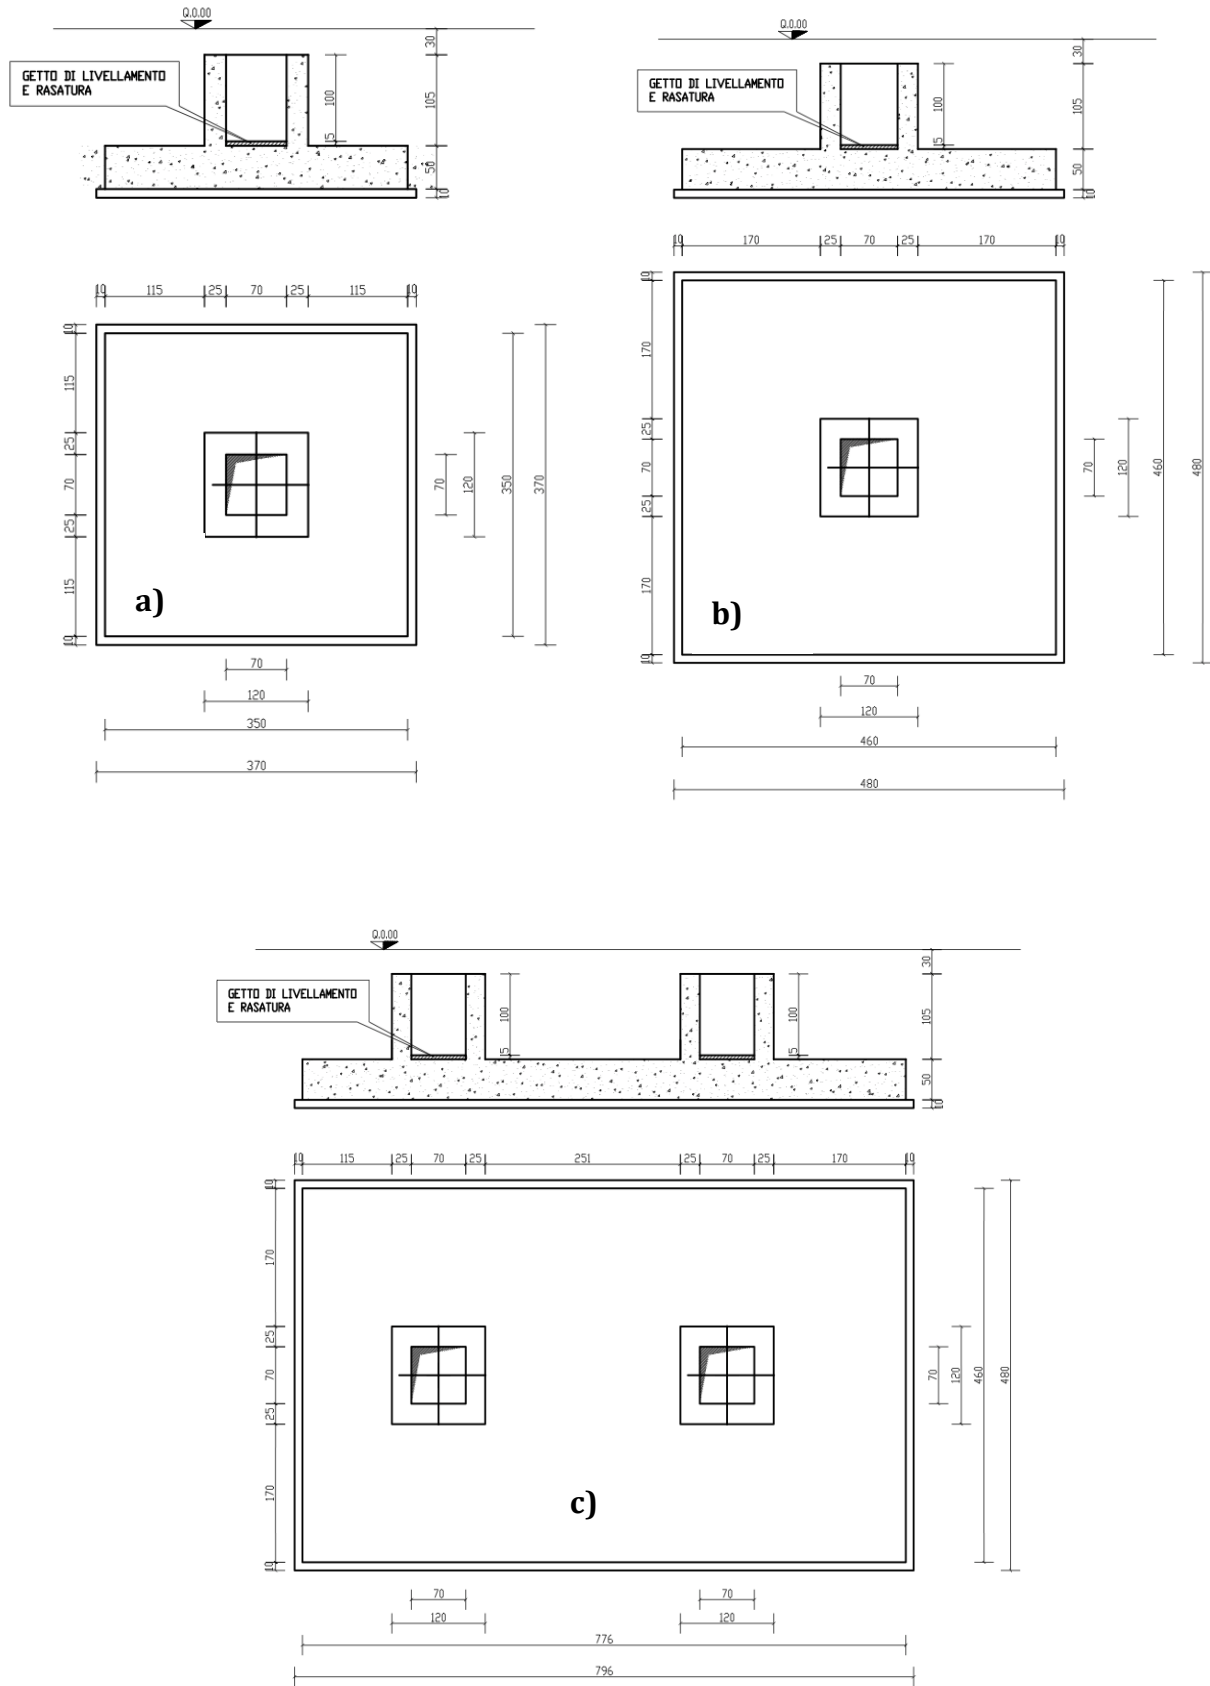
Plinti a bicchiere prefabbricati per edifici industriali
